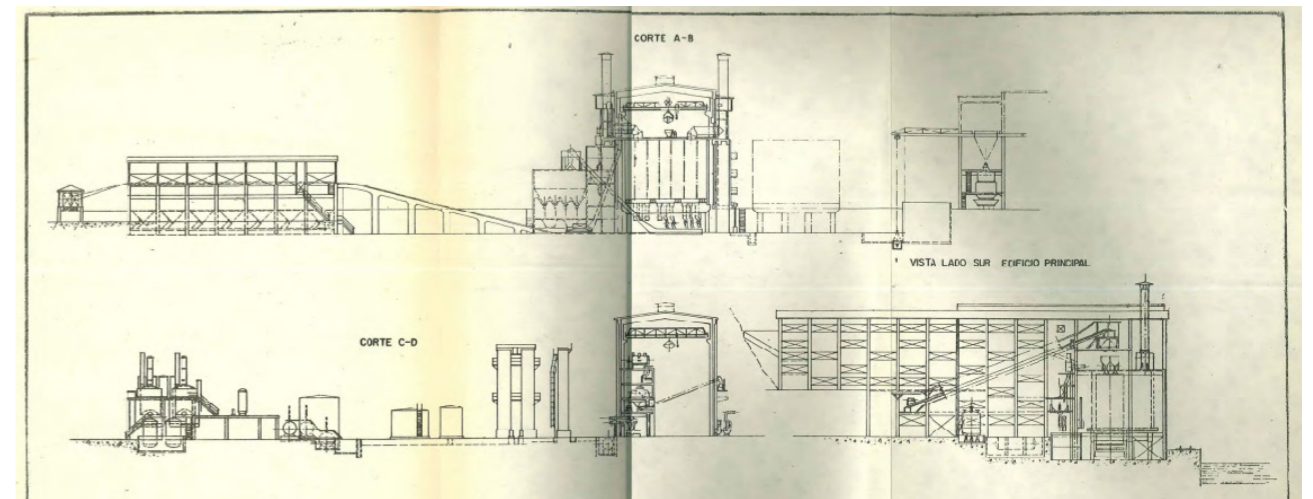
Planimetría original de la Planta Purificadora de Carbón. Secciones del proyecto completo. Fuente: Libro "El Proyecto Pupunahue de la Corporación de Fomento, Vogel Meyer, 1959.
